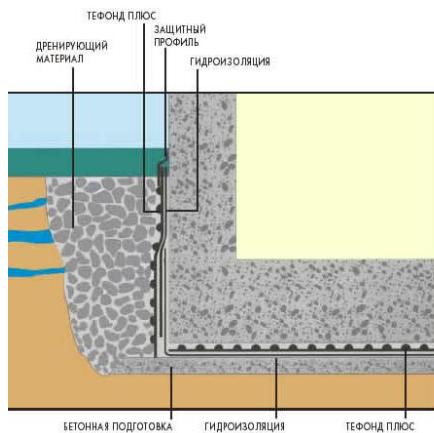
Фундаментная плита при наличии грунтовых вод
